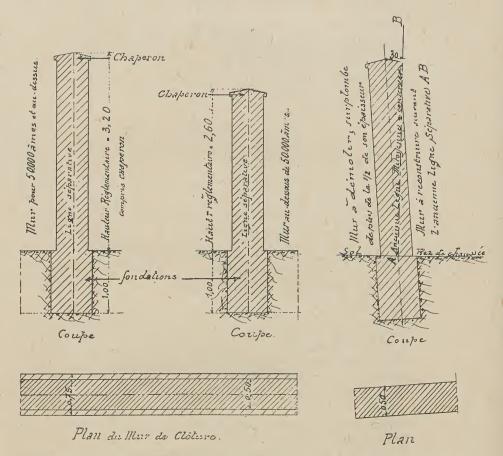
Murs de clôture dans les villes et faubourgs. Plan et coupes.
